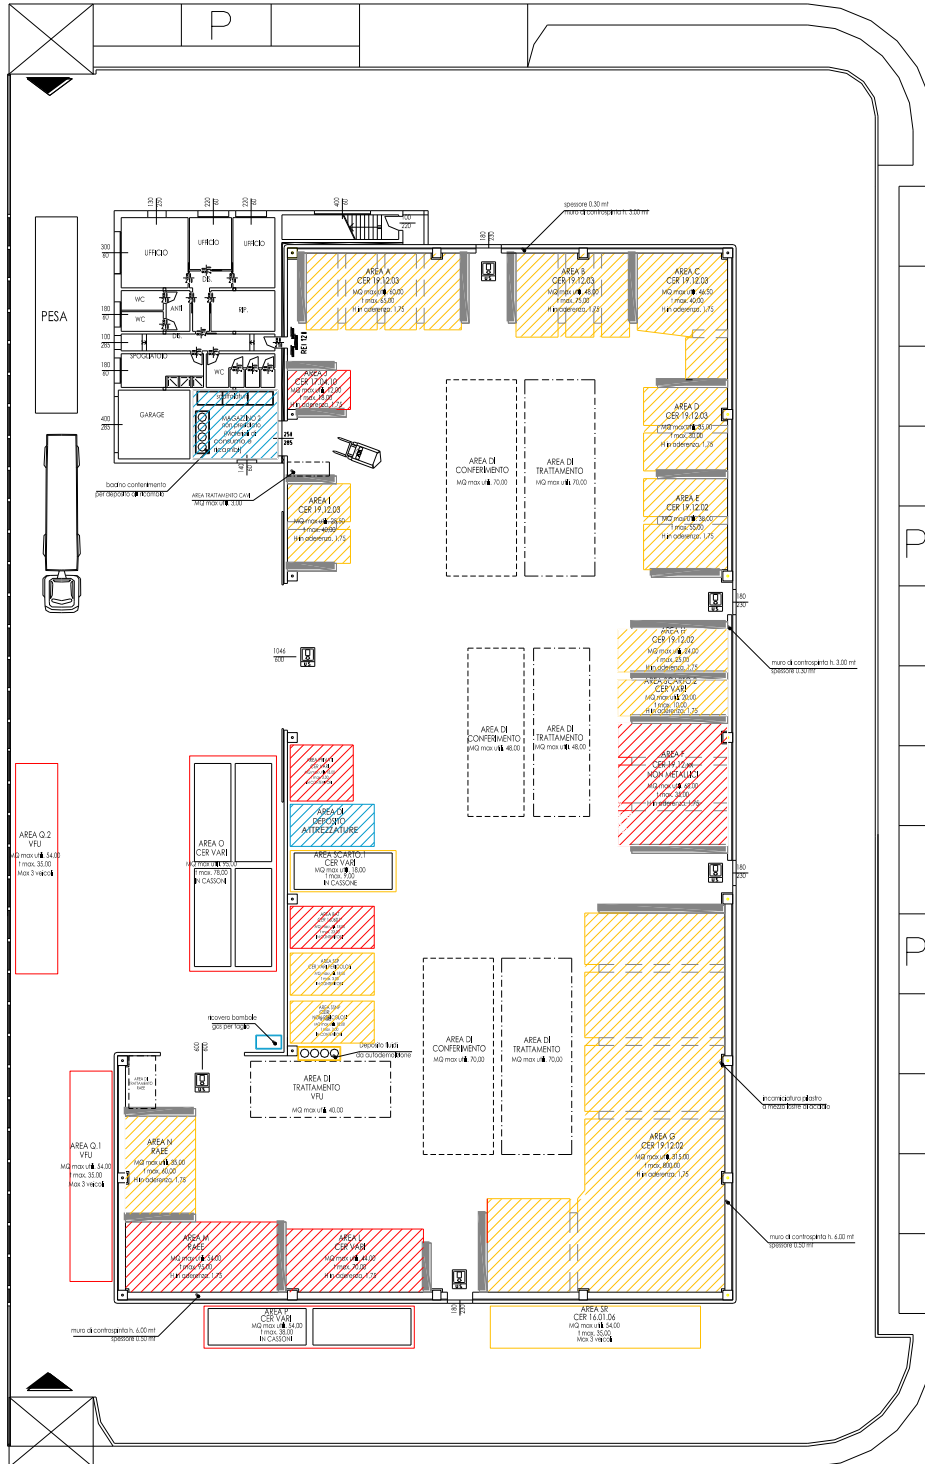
Estratto della Planimetria A 2.15 “Layout impianto di gestione dei rifiuti”
